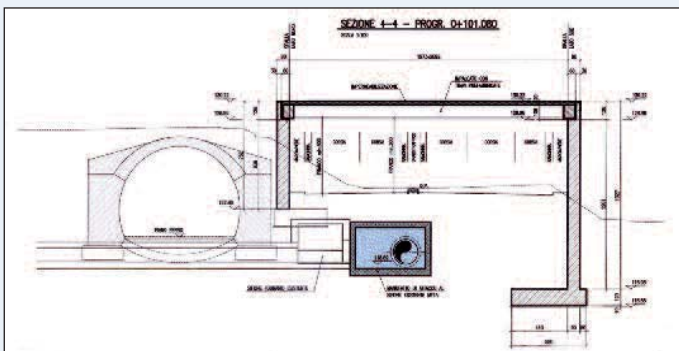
La sezione del tunnel in aderenza al Passante Ferroviario
